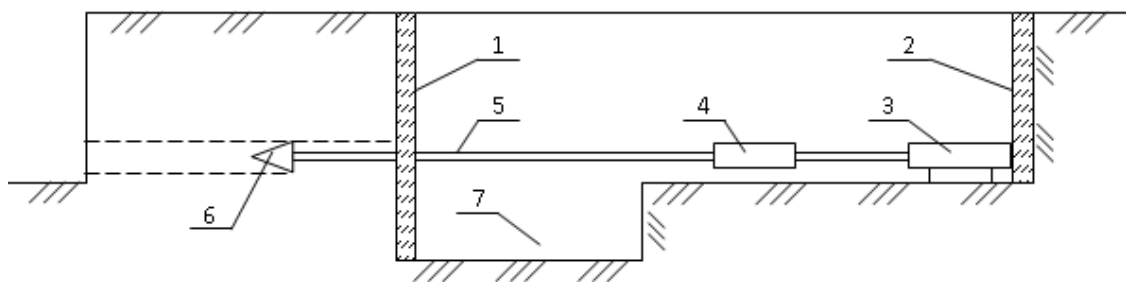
Прокол: 1 - крепление передней стенки котлована; 2 - упор на задней стенке котлована; 3 - гидравлический домкрат; 4 - нажимные патрубки для передачи давления домкрата трубе; 5 – труба; 6 – наконечник; 7 - приямок для наращивания трубы
